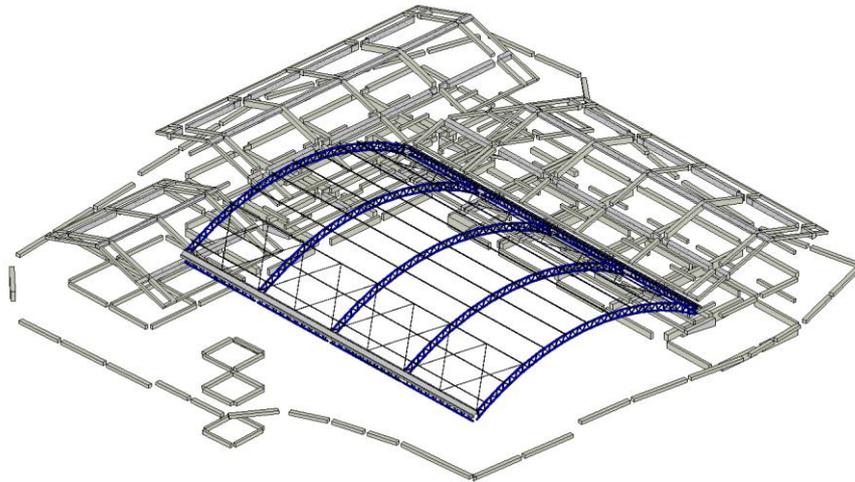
Categoría Armazón Estructural aislada del modelo federado de Estructuras
